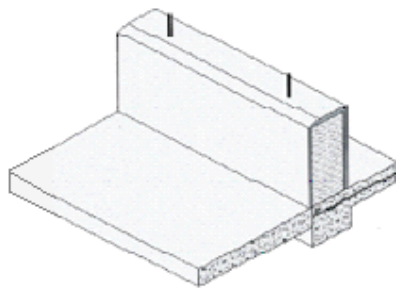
Murete o Brocal construido en mampostería de bloques de concreto y refuerzo de acero
